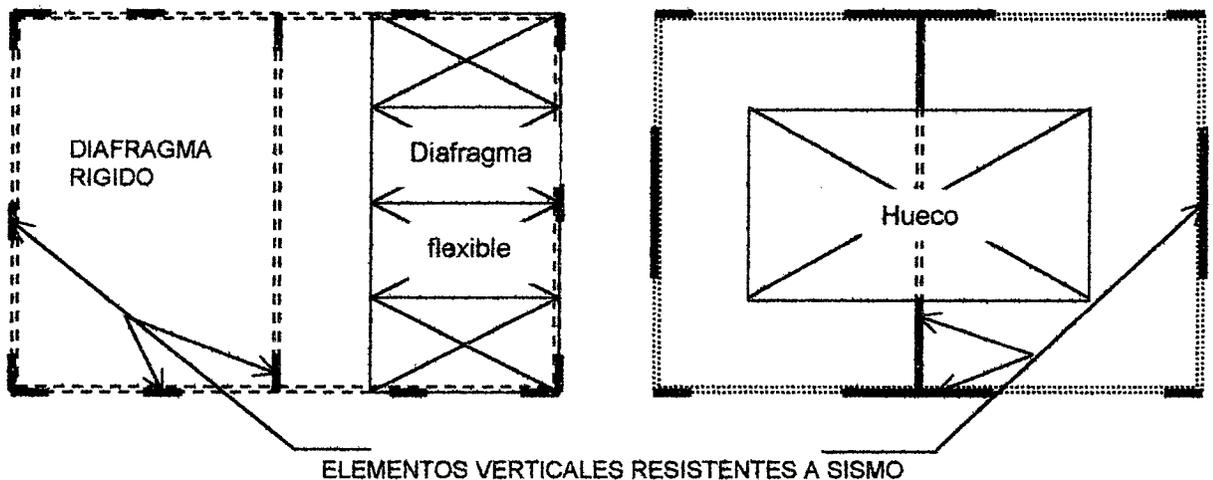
c Diafragmas de piso de distinta rigidez
